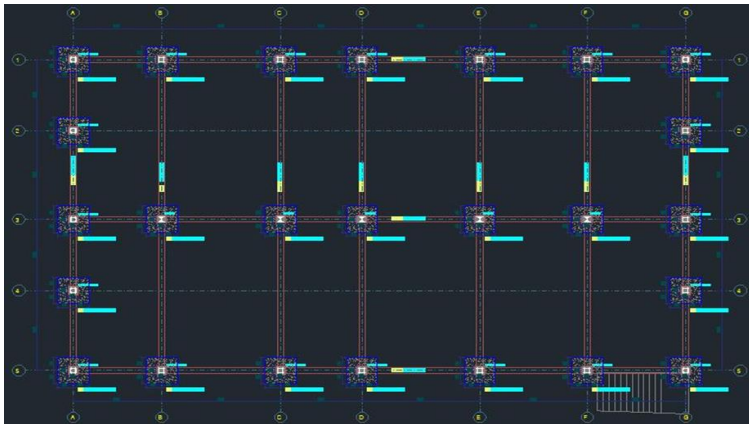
Plano arquitectónico en planta de consulta externa.
